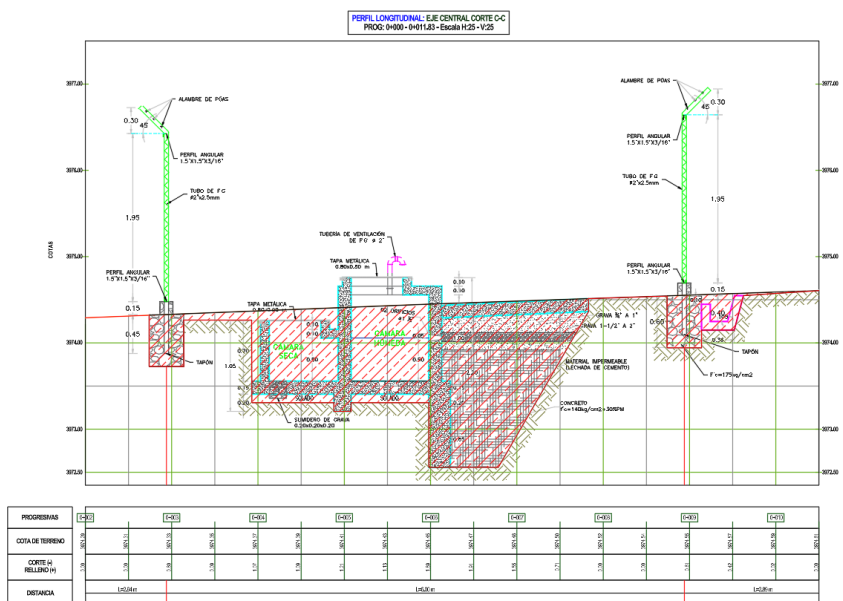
Perfil Longitudinal de la captación Las Guachas.
